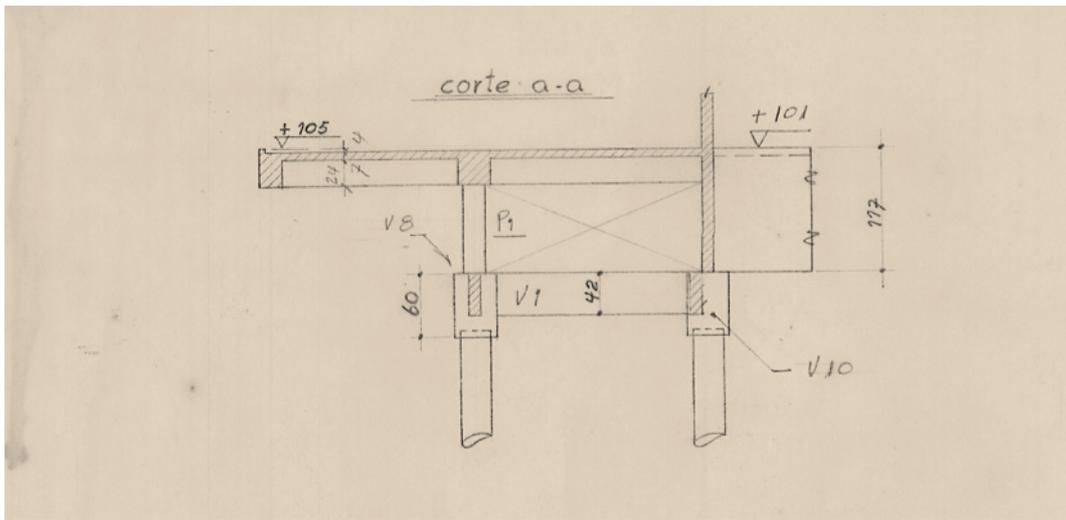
Detalhe estrutural do balanço da plataforma do Pavilhão do Flamengo e união com o muro curvo de concreto para contravento-lo
